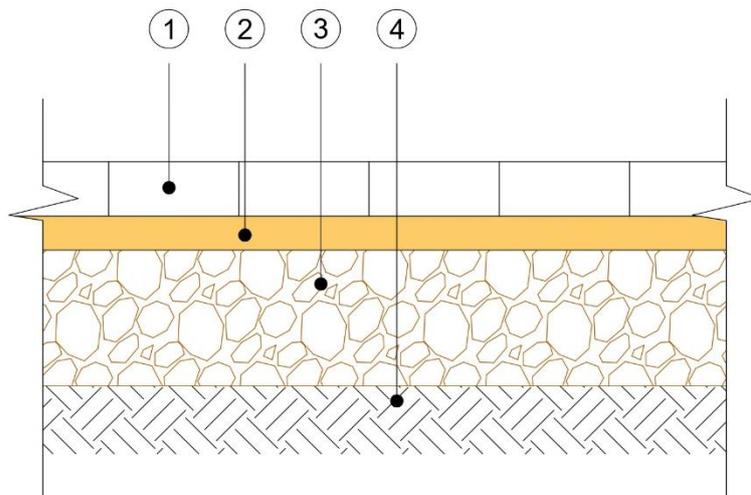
Anteproyecto vial: ejemplos de obras de pavimentación en la ciudad.
